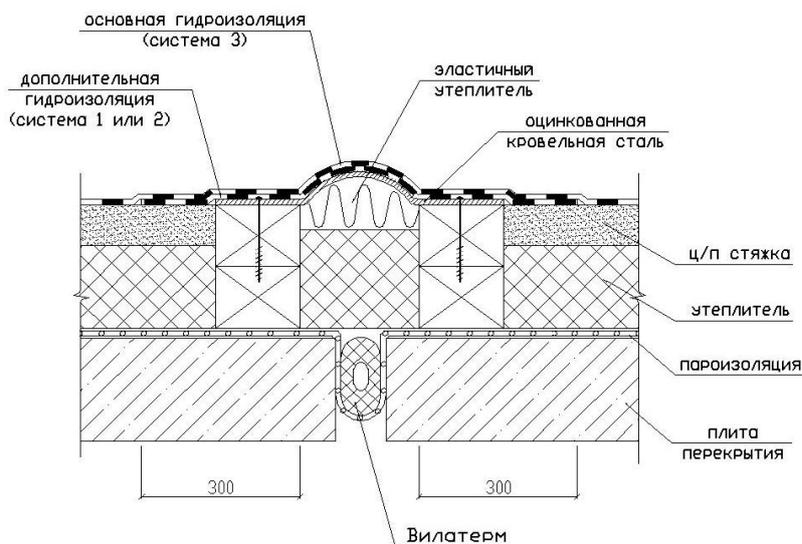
Устройство гидроизоляции деформационного шва с использованием каркаса из кровельной стали.
